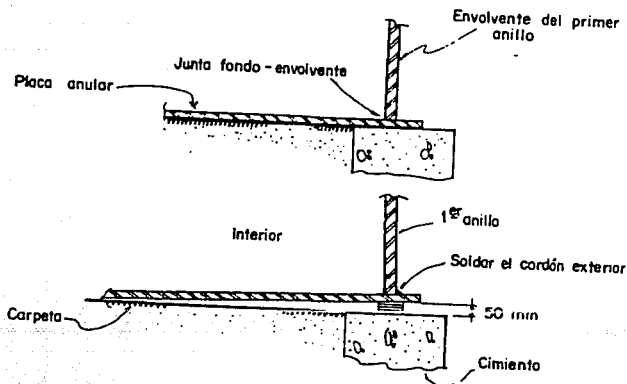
Soldadura de la junta fondo envolvente 1er. anillo.
